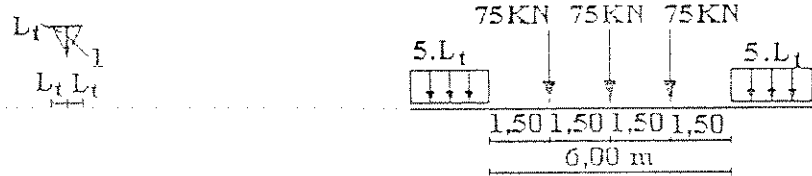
DEFINIÇÃO DO TREM-TIPO PARA CÁLCULO DAS VIGAS PRINCIPAIS DE PONTES CLASSE 30
